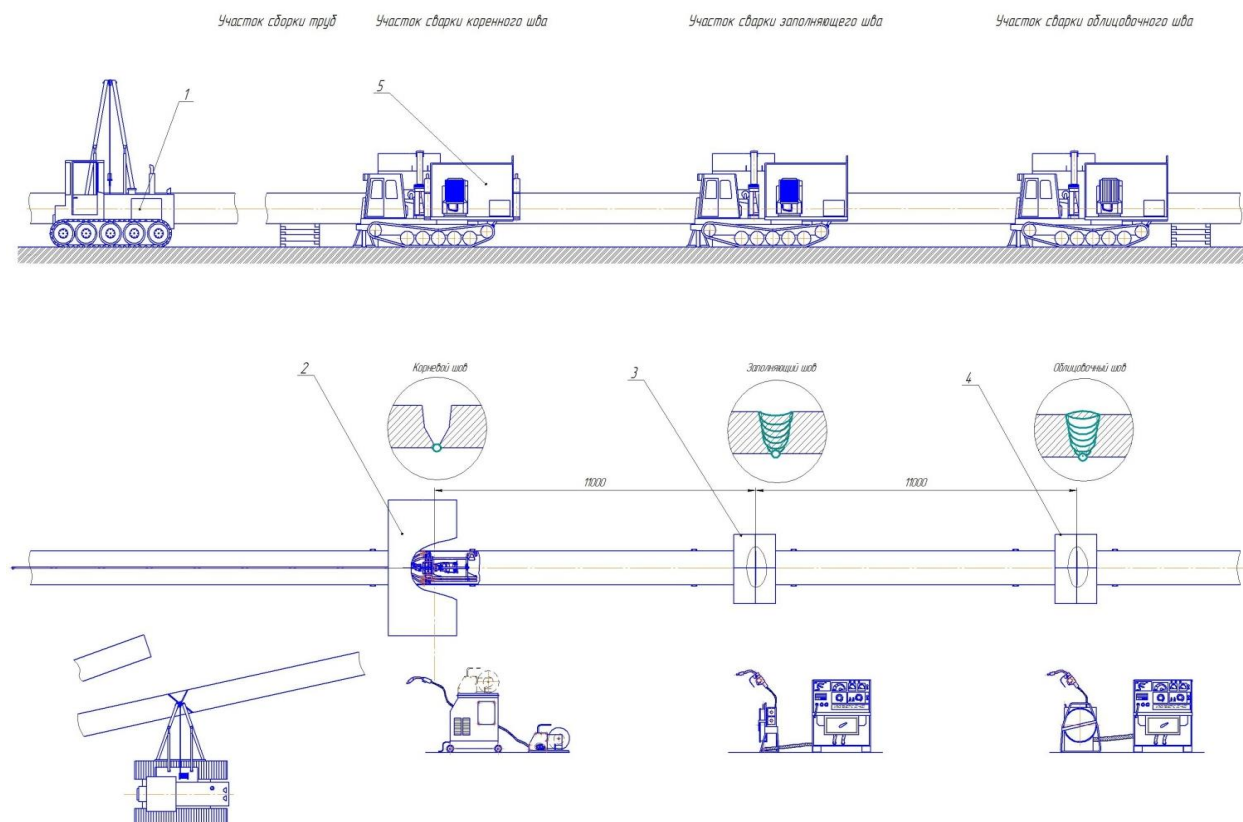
Поточно-расчлененный метод сборки и сварки
